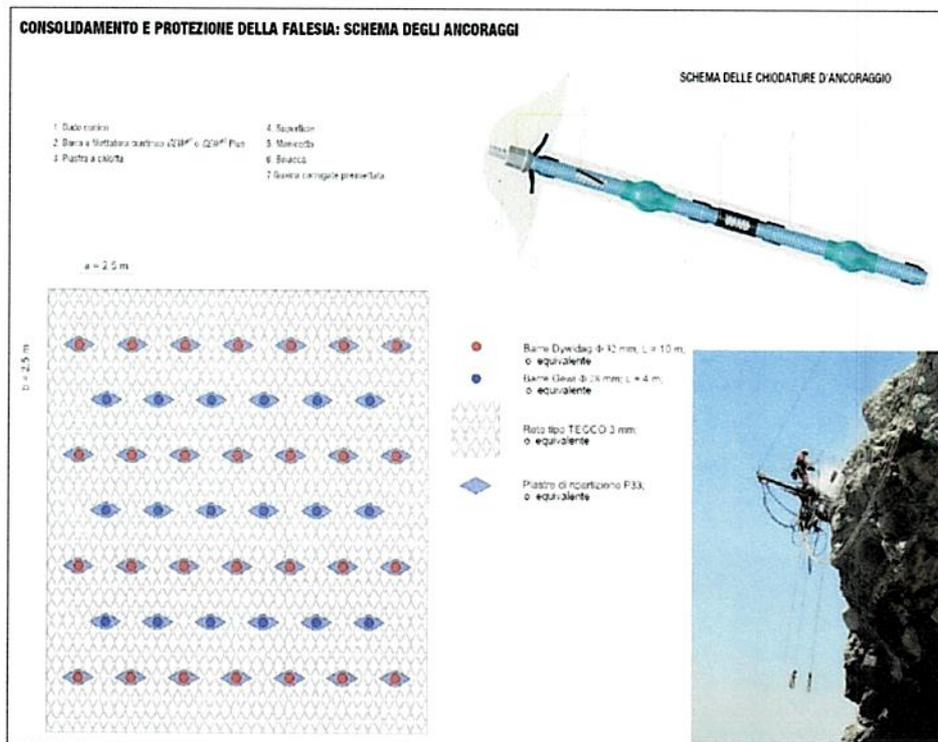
caratteristiche rete di protezione (elab. OP.04)
